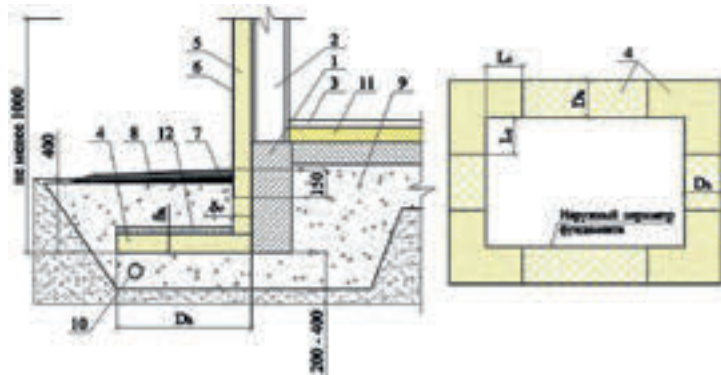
Схема укладки и параметры теплоизоляции в фундаментах отапливаемых зданий с теплоизоляцией пола для жилых, общественных и производственных зданий
